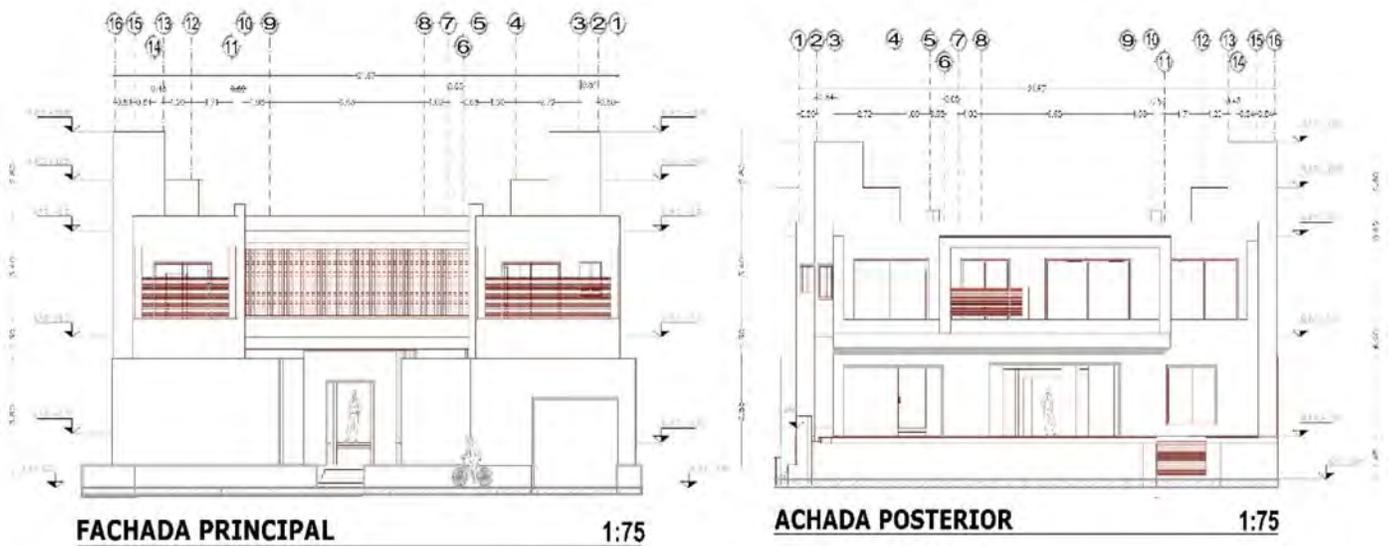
Y 2.2 FACHADAS DEL EDIFICIO
